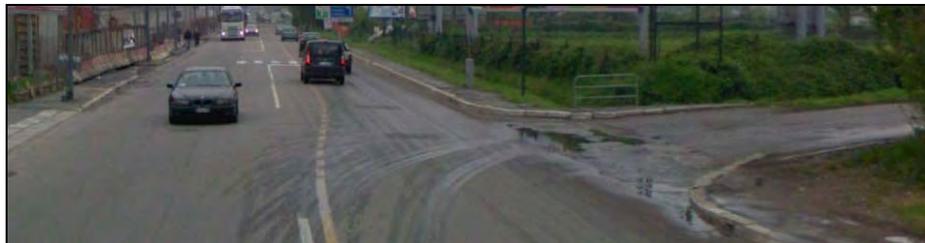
Intersezione “D” / “E” – Via Gallarate / Via Capo Rizzato
